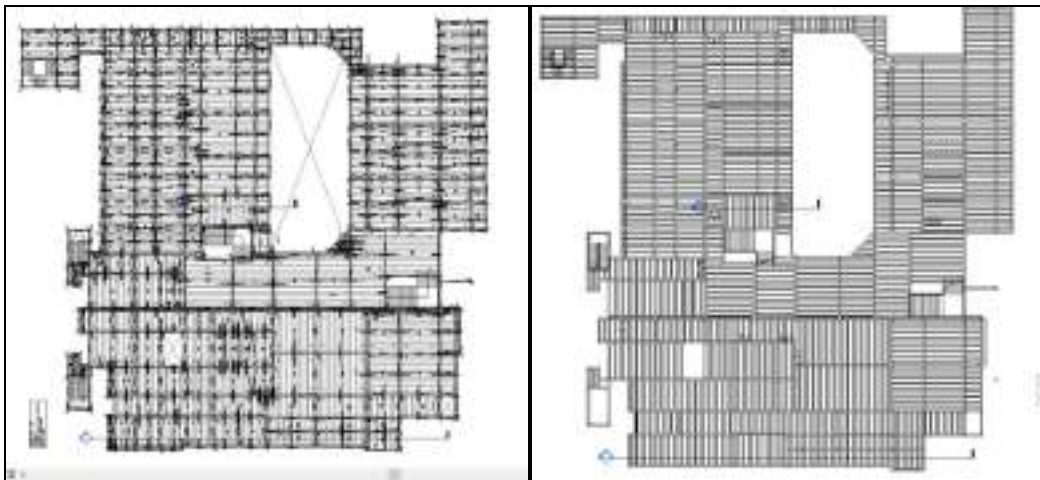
Autodesk Revit – Generación de planos estructurales en planta
